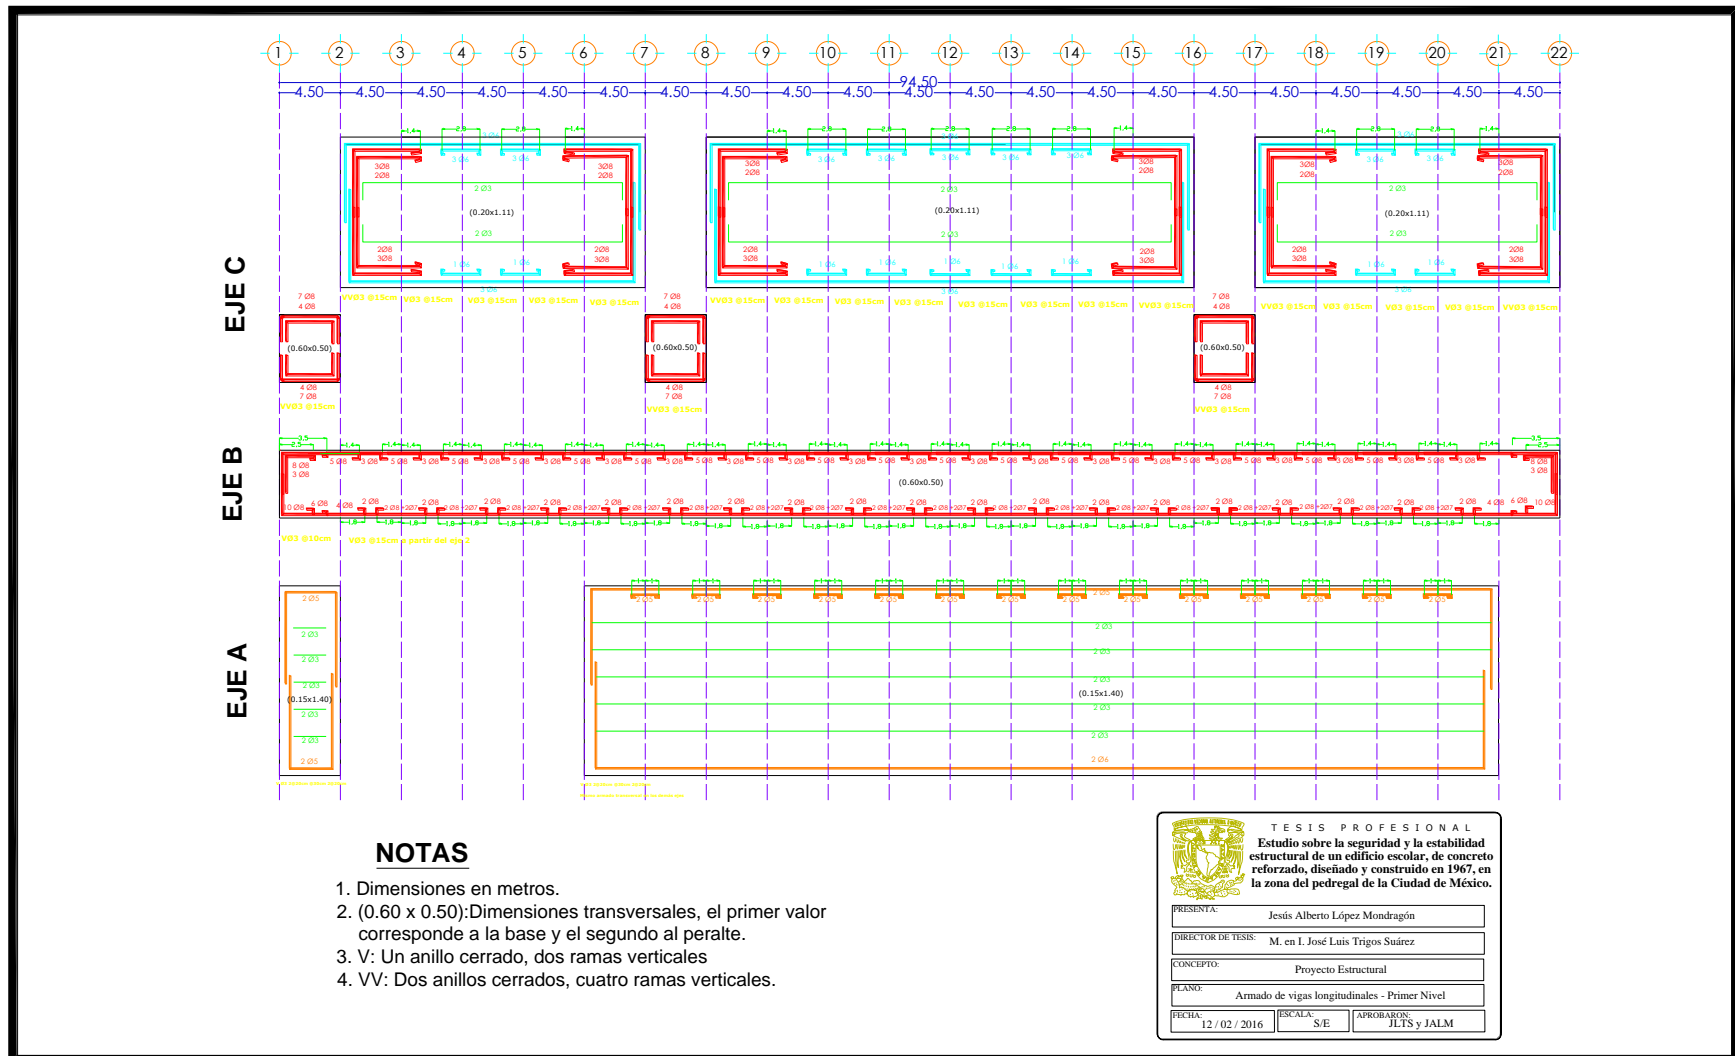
Armado de vigas longitudinales - Primer nivel
